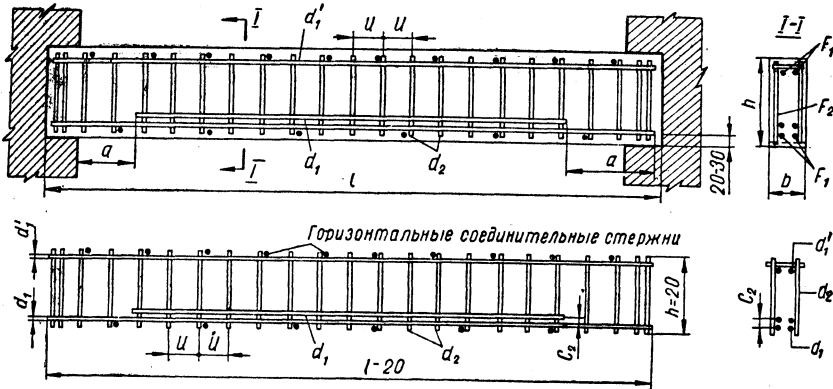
Армирование однопролетной балки сварными каркасами.
